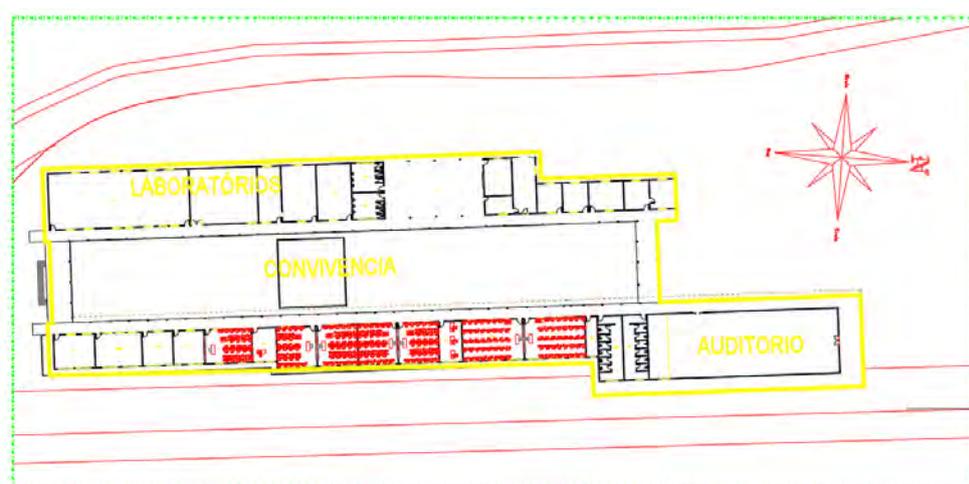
Planta baixa do Bloco Pedagógico do Campus São Gabriel da Cachoeira
